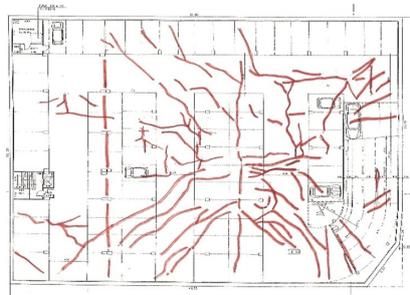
Mapa de fisuras por subpresión en losa de cimentación
